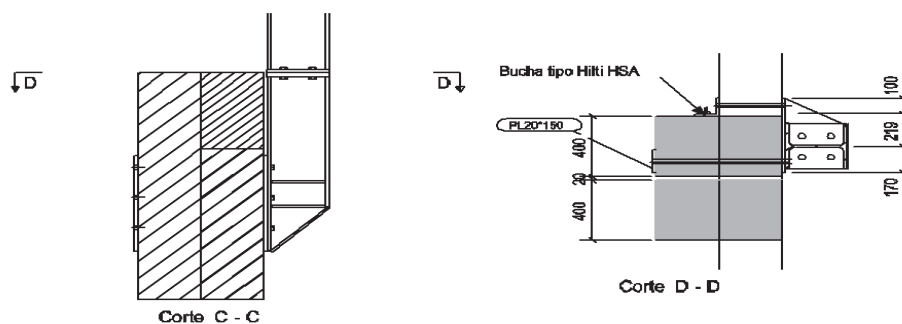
Pormenor de ligação do pilar com excentricidade para evitar coincidir com a junta de dilatação do edifício existente.
